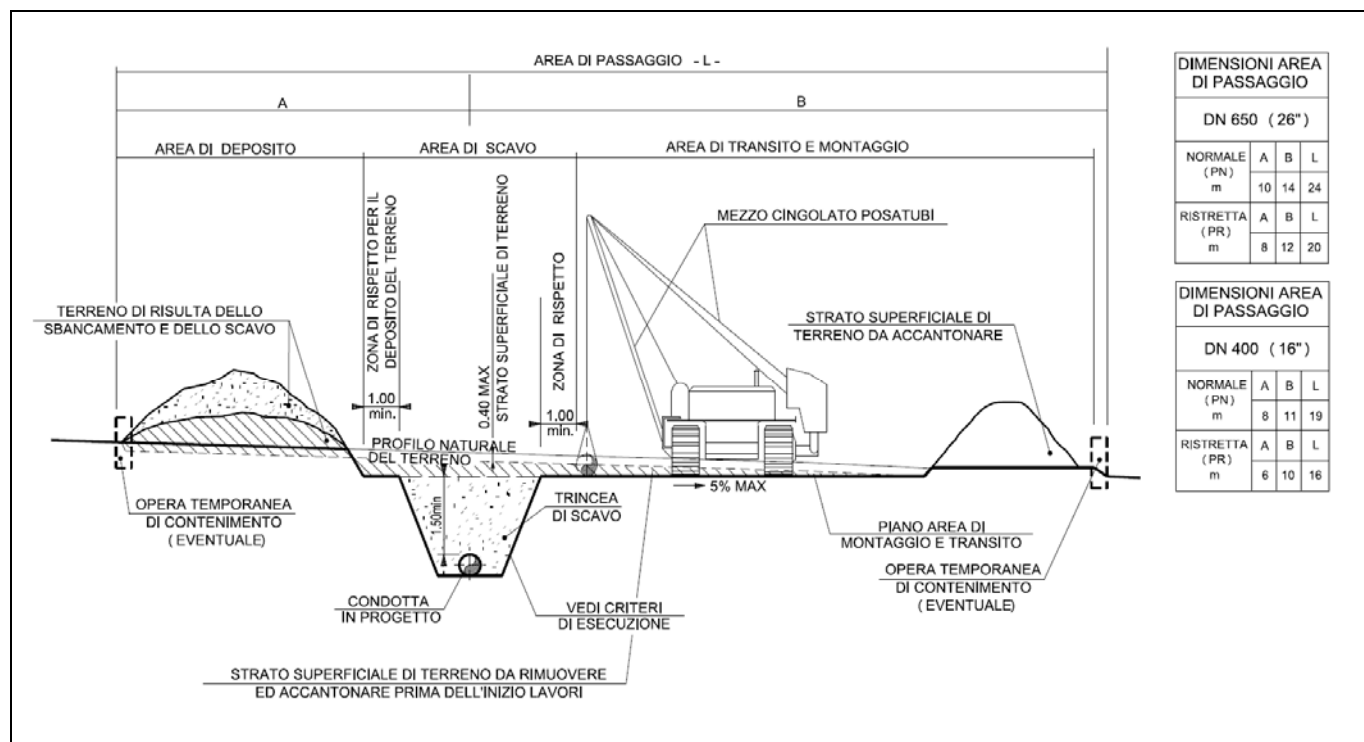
Sezione tipica dell'area di passaggio per posa condotta
